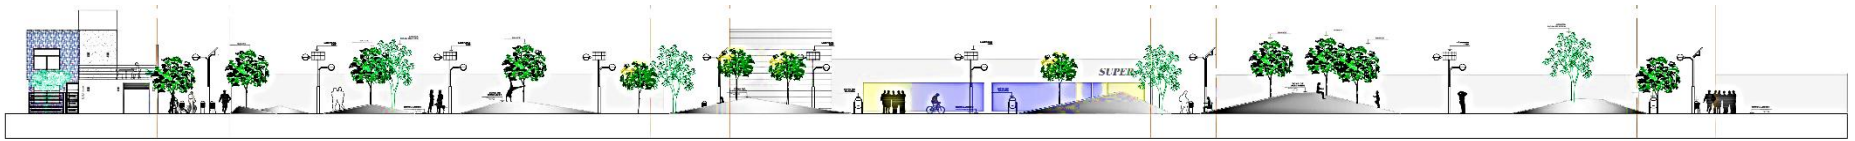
Alzado de la plaza principal [Corte "A"]. Plano de elaboración propia, 2017.
